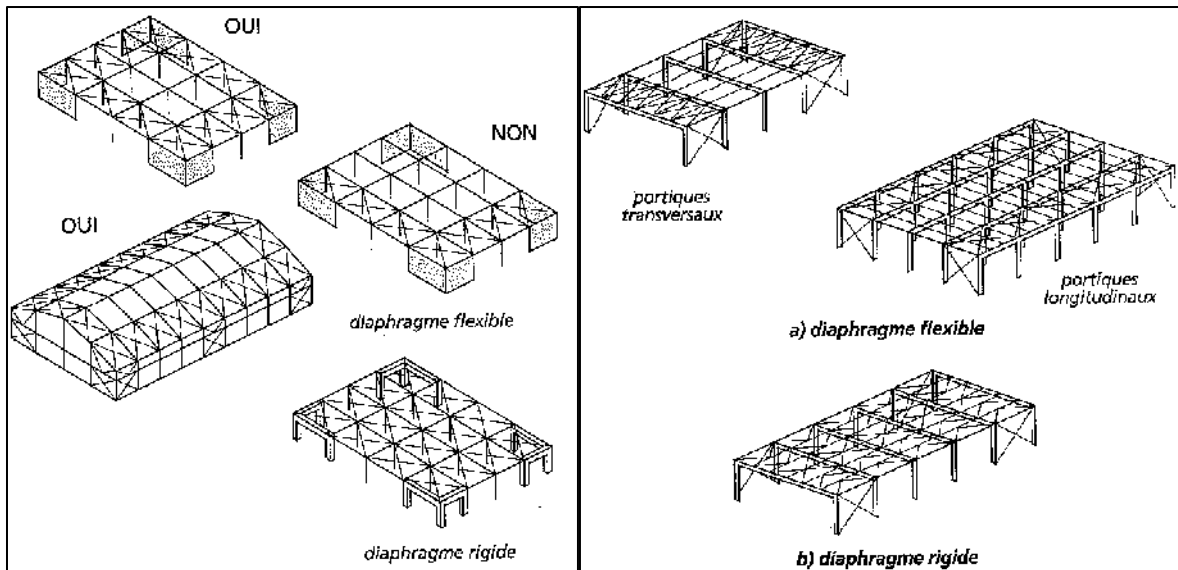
Diaphragmes à poutres au vent. Gauche: systèmes poteaux-poutres articulés - Droite: Systèmes en portique [R21]
